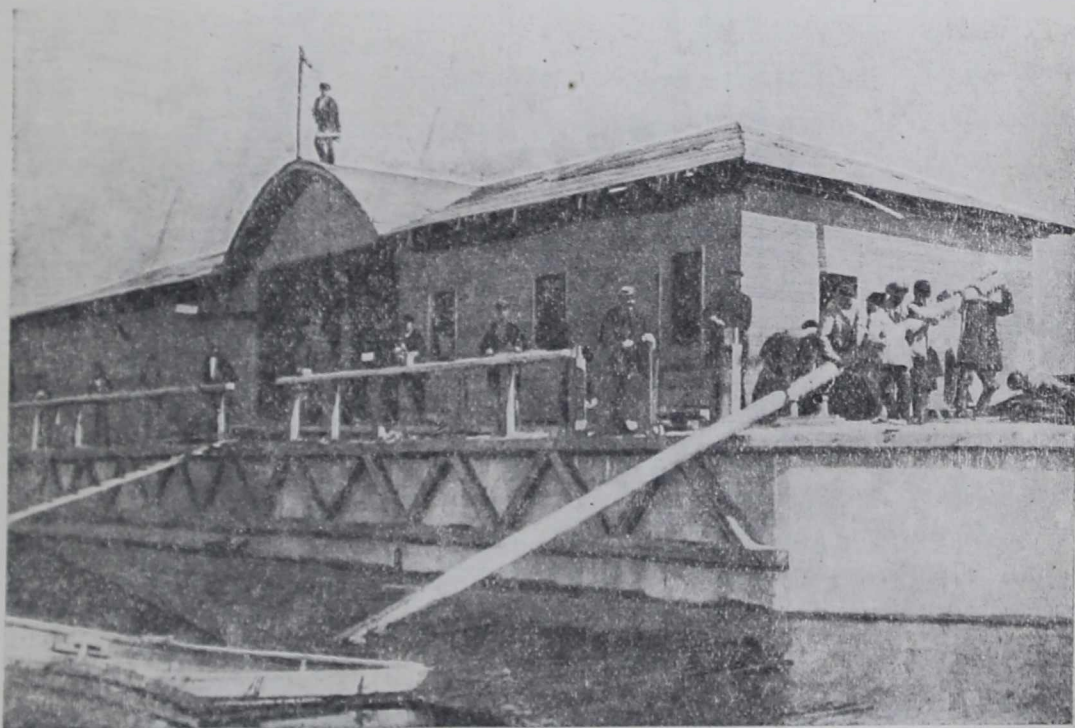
Ремонт железобетонного парохода „Nagara“.
